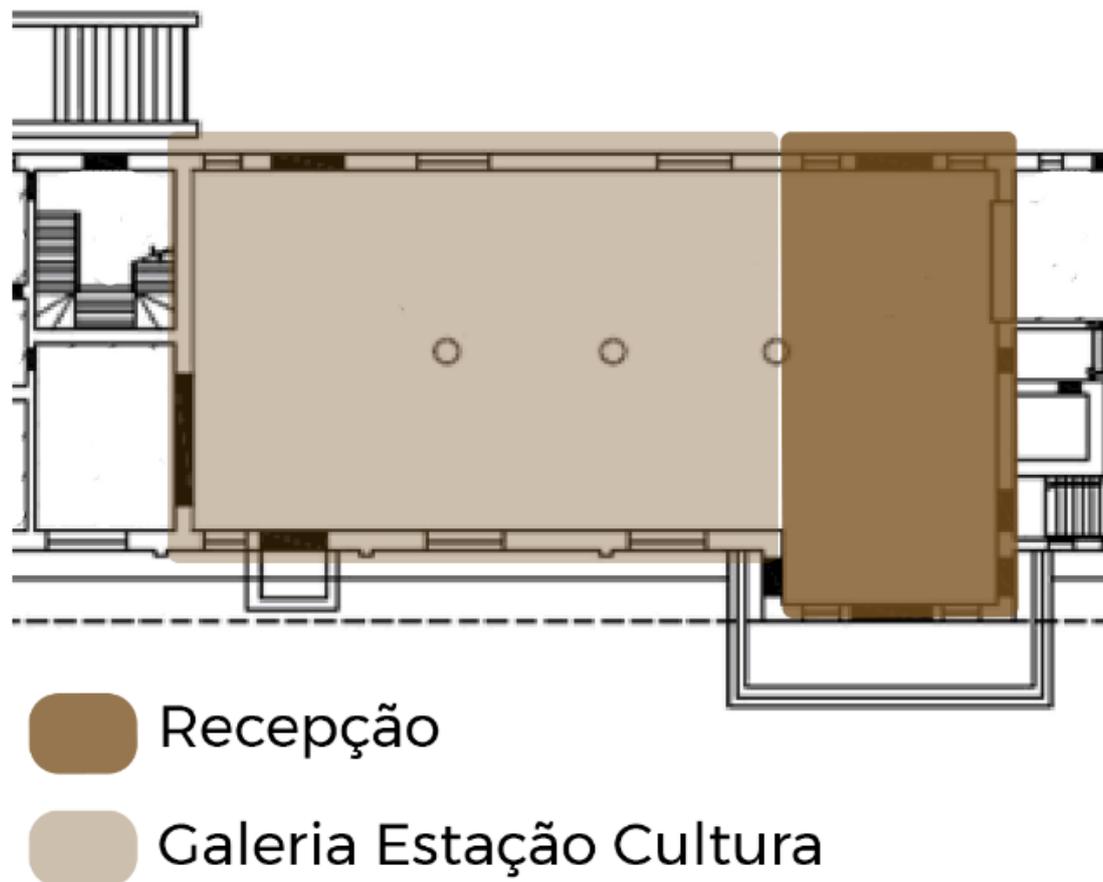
Planta da galeria da estação Cultural. Fonte: Esquema elaborado pela autora.
